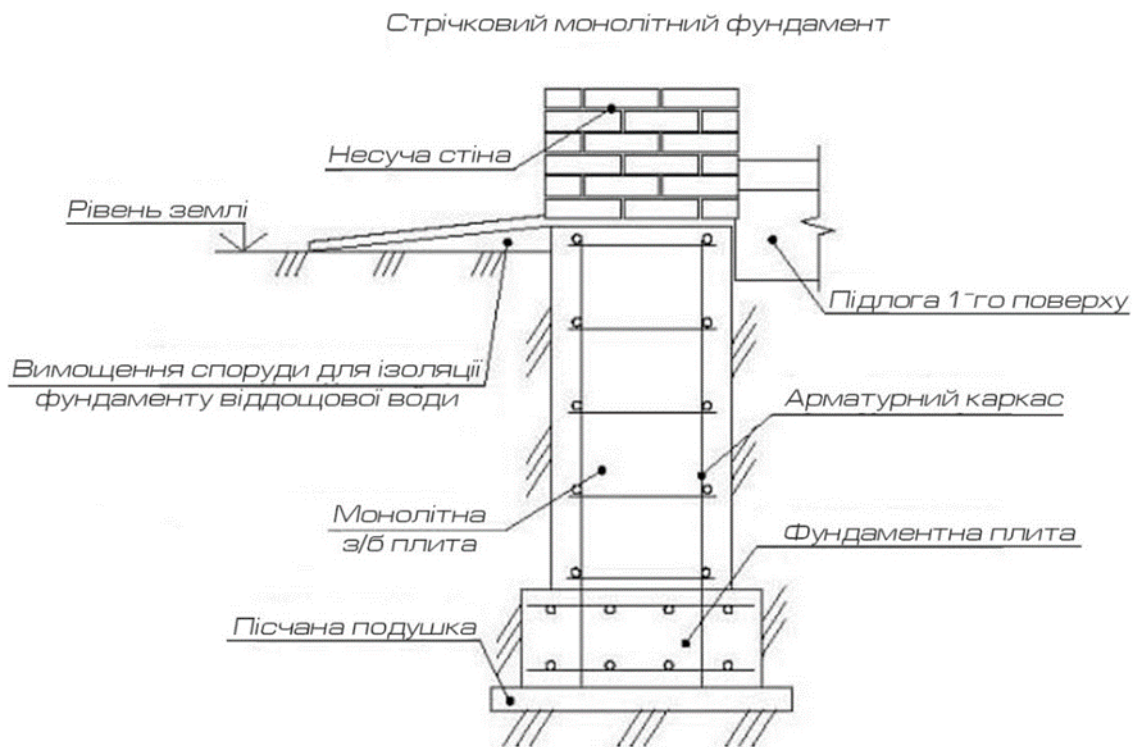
Стрічковий фундамент будівлі з підвалом
